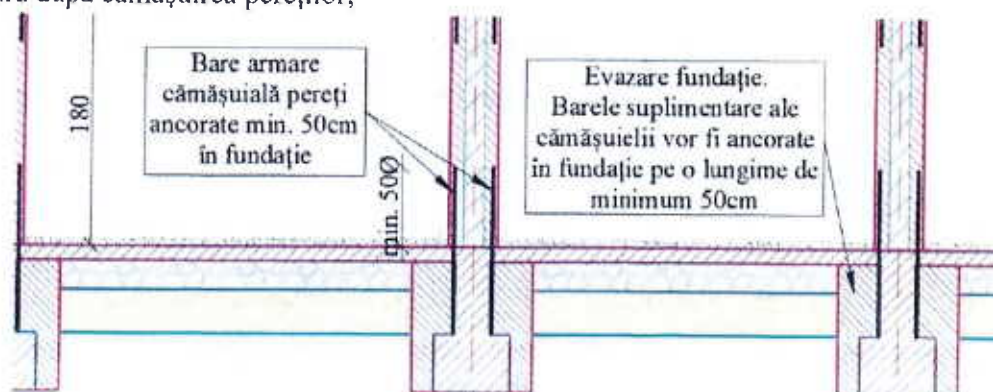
Ancorarea armăturilor în fundație și evazarea secțiunii de beton
